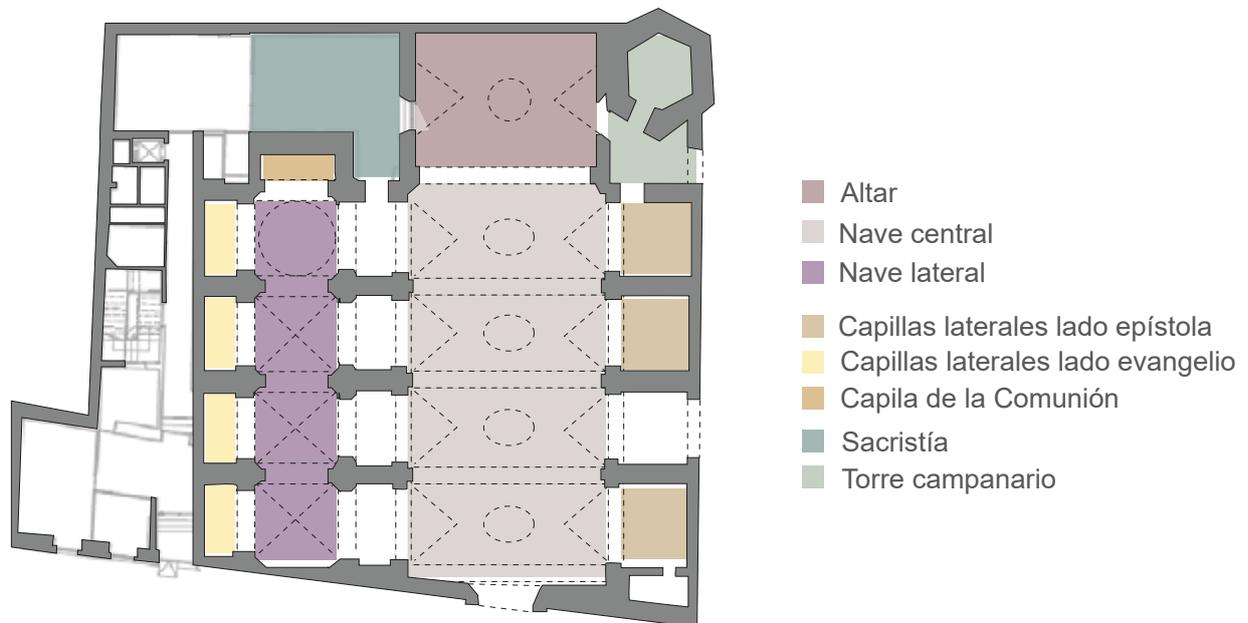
Planta baja de la Iglesia de San Lorenzo, elaboración propia.
